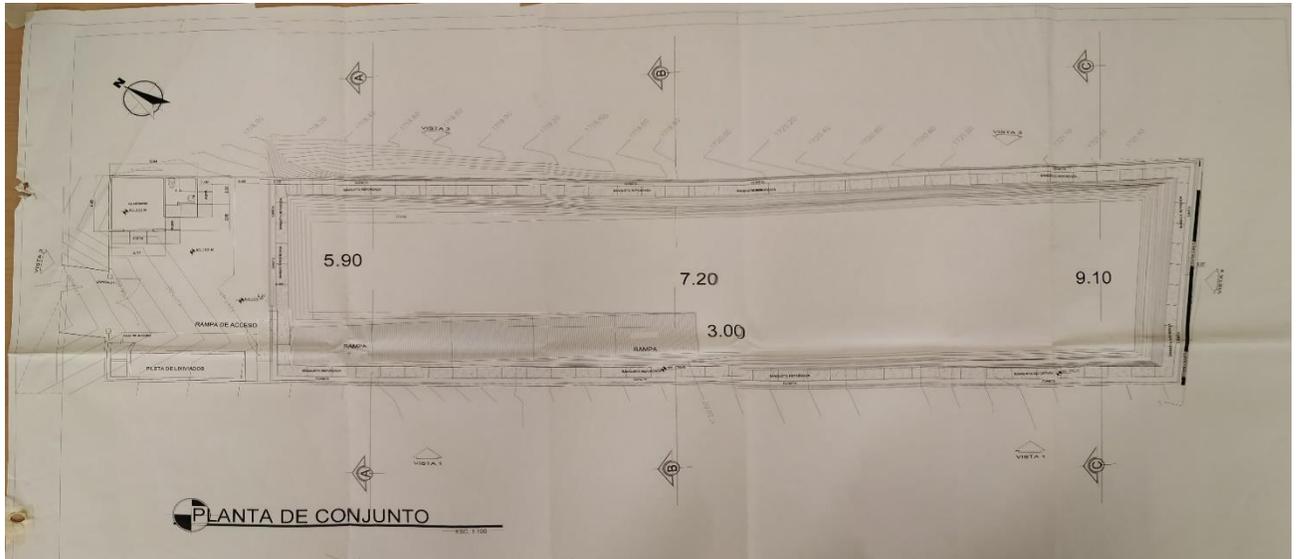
A. Plano planta de conjunto, relleno sanitario municipal.
